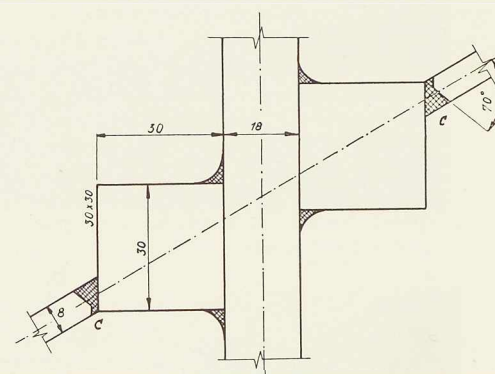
Soudure des âmes d'une entretoise et d'une poutre principale (joint C).
